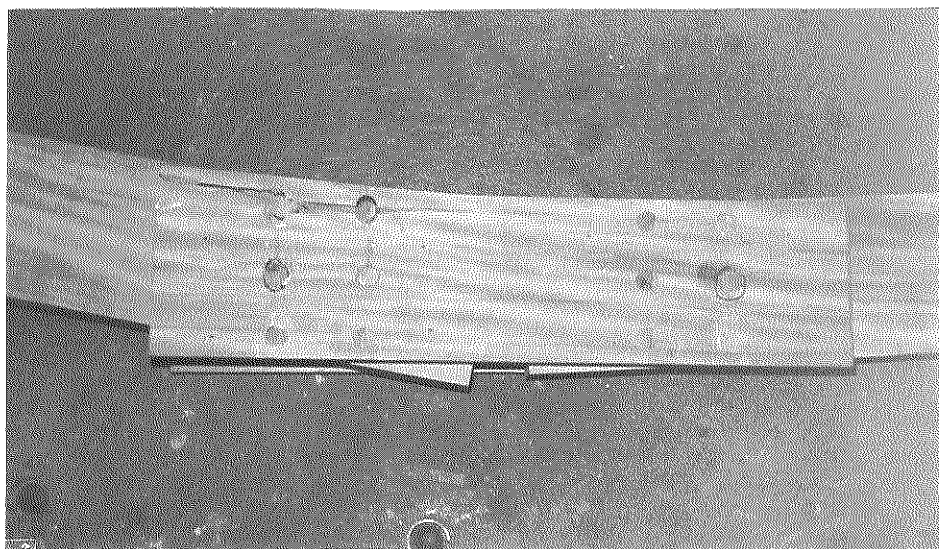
Ruptura de uma viga com emenda cavilhada
